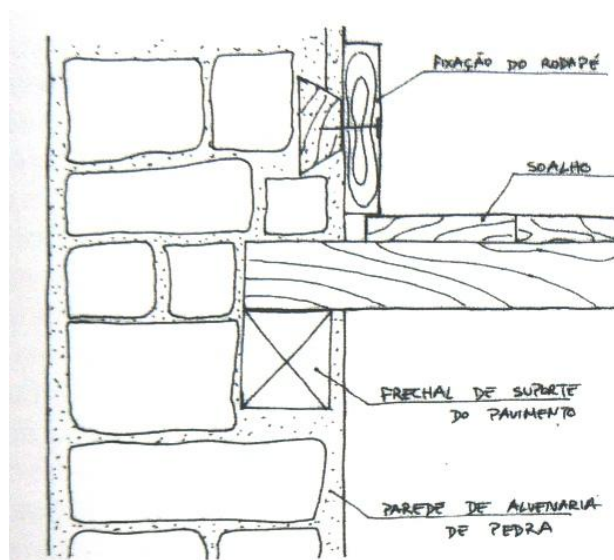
Pormenor do pavimento de ligação entre pisos. [10]
